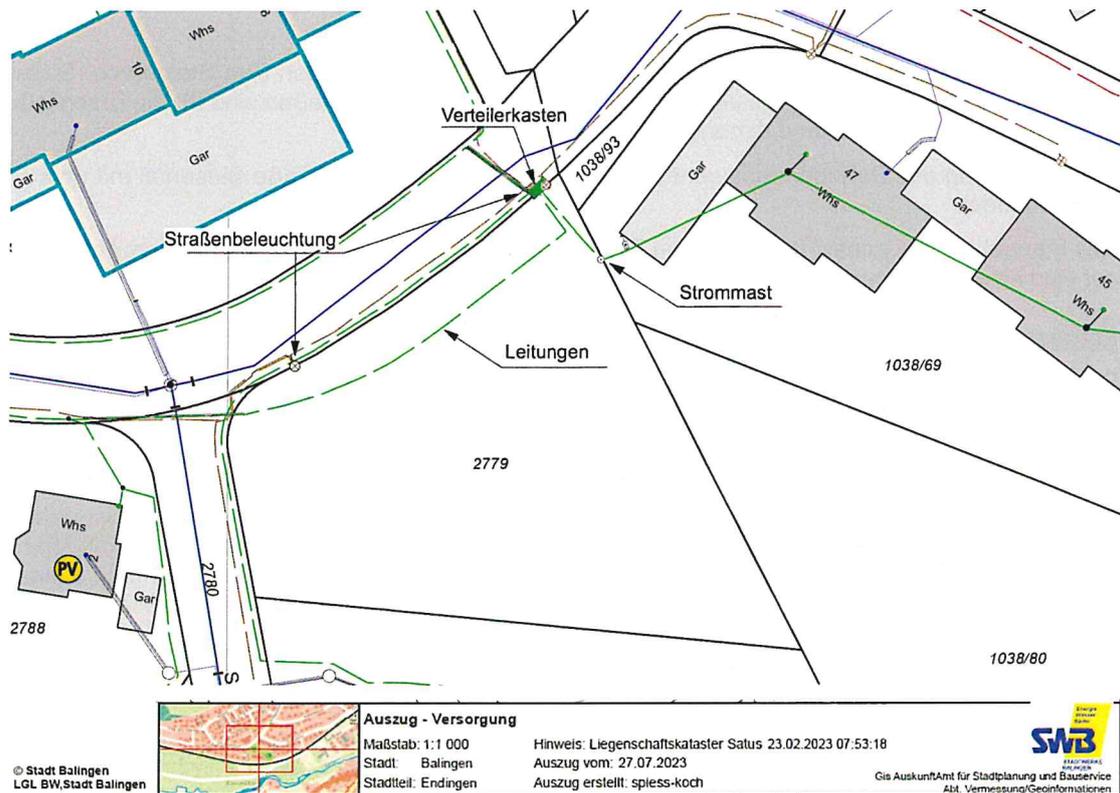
Lage Bestandsleitungen, -anlagen im Plangebiet
